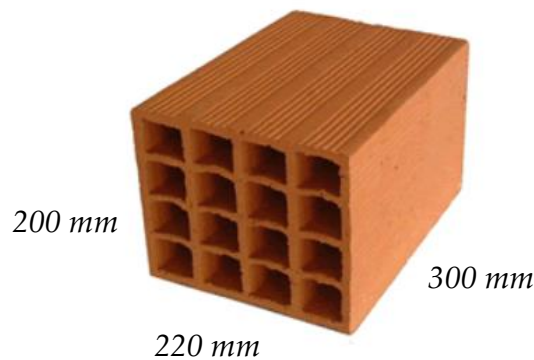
Dimensões de fábrica do tijolo de 22 (adaptado de [30]).
